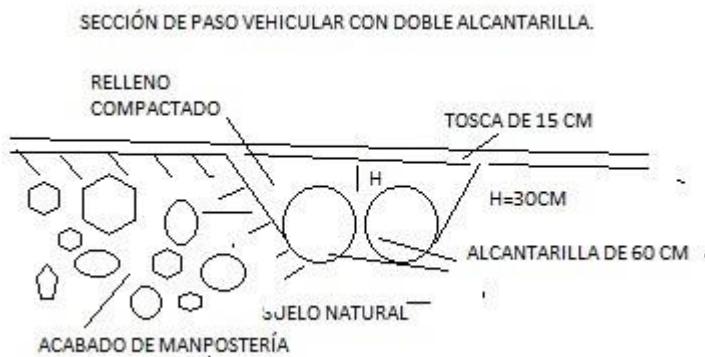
Sección de paso vehicular de alcantarilla
